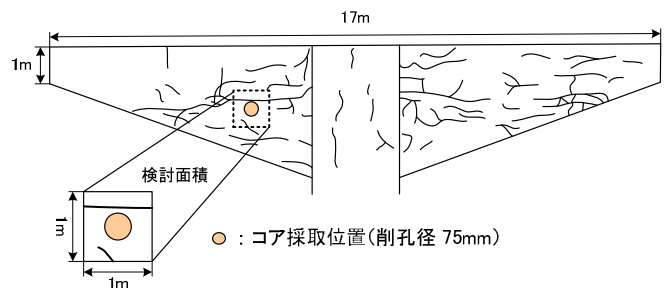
橋脚のひび割れ損傷例およびコア採取位置の検討面積
